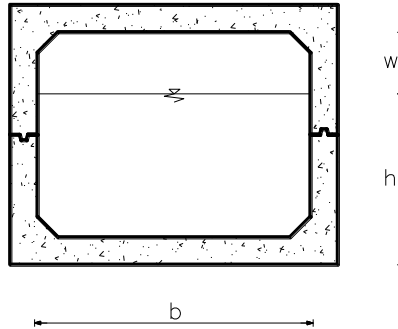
Potongan Memanjang Sudetan *Box Culvert
